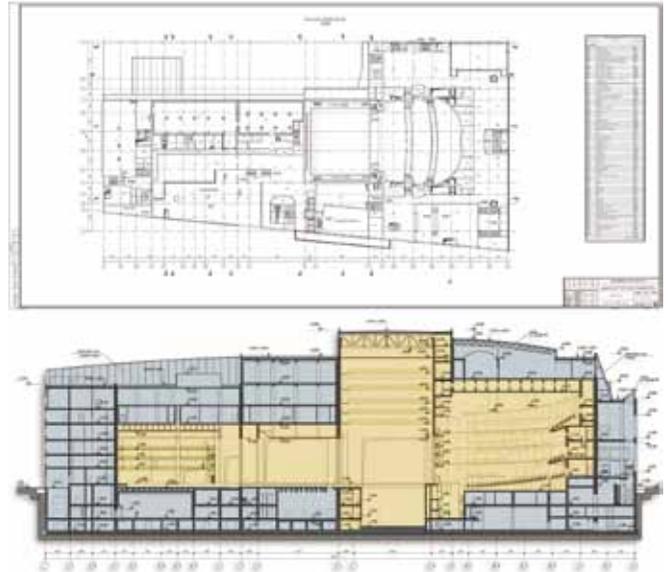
План пятого этажа на отметке 20.740 и продольный разрез здания
